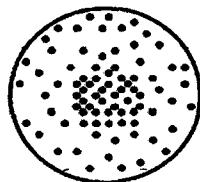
Pobre distribución del lanzado sobre el corte transversal.
